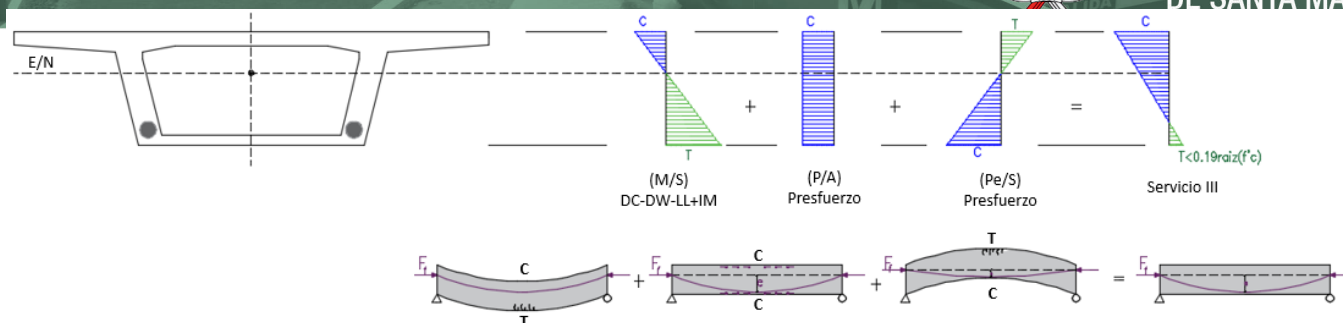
Distribución de esfuerzos en flexión del concreto Puente viga Cajón
